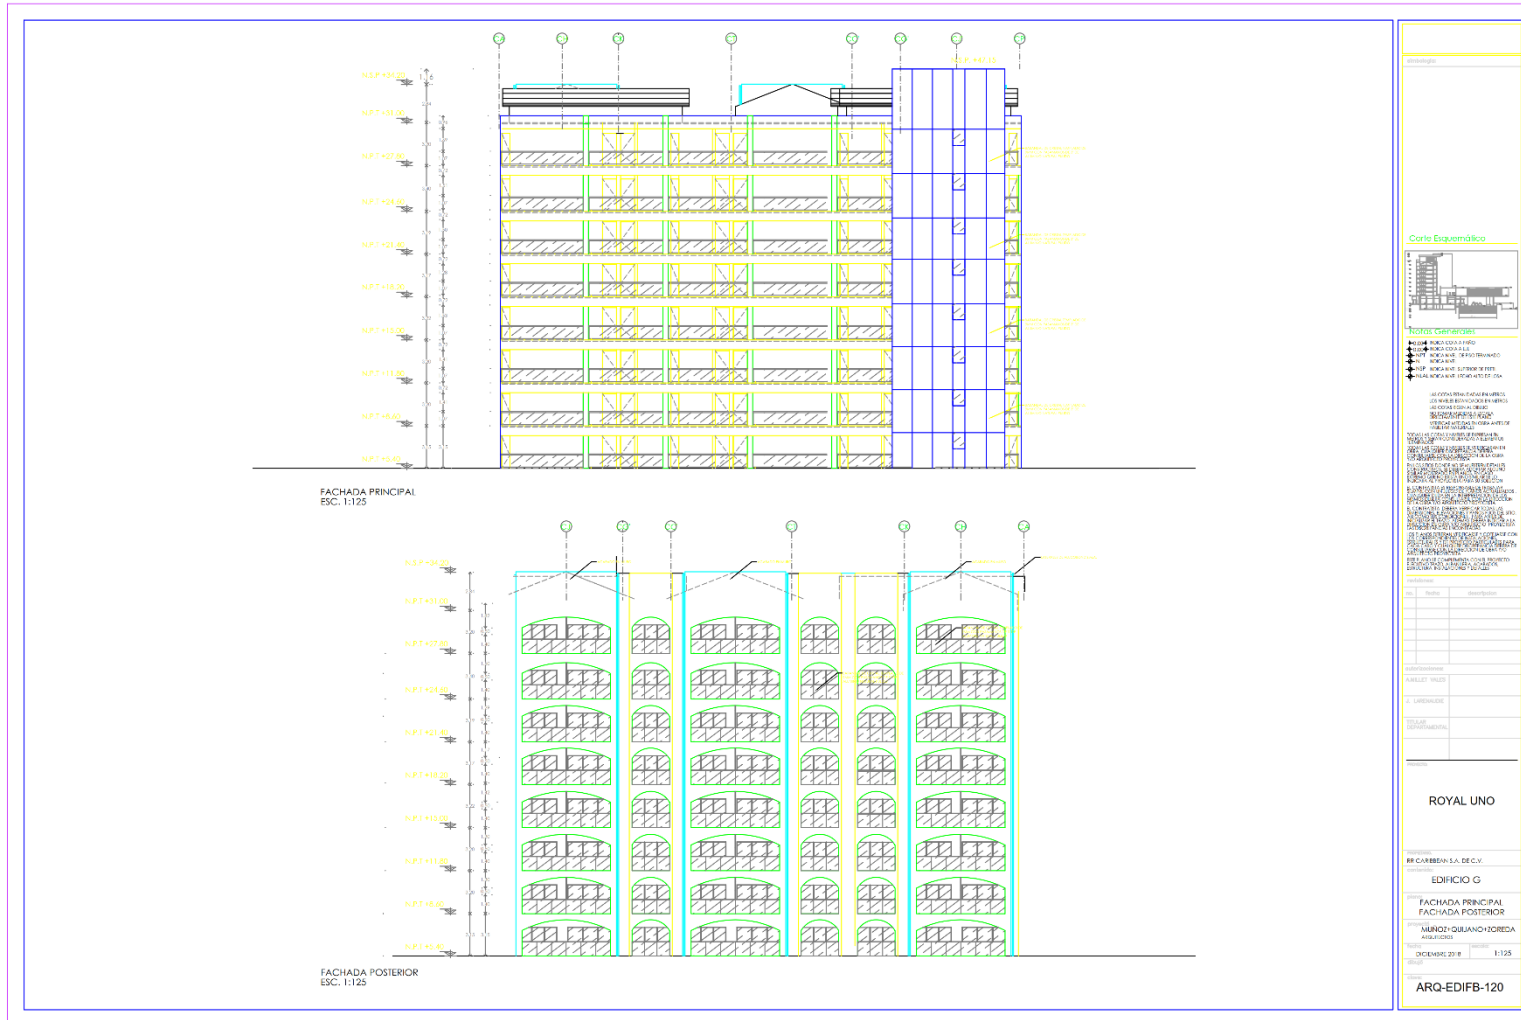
Edificio G, Fachada posterior y principal. Anexo C-7.
